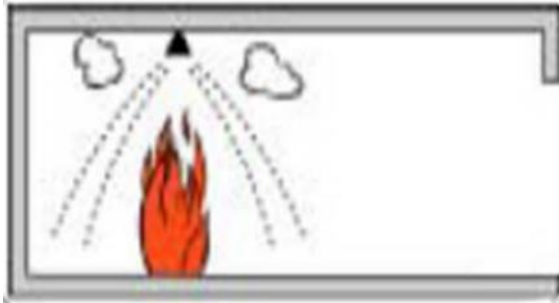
On prévoit des SPRINKLERS. Source: <http://ww2.ac-poitiers.fr>
